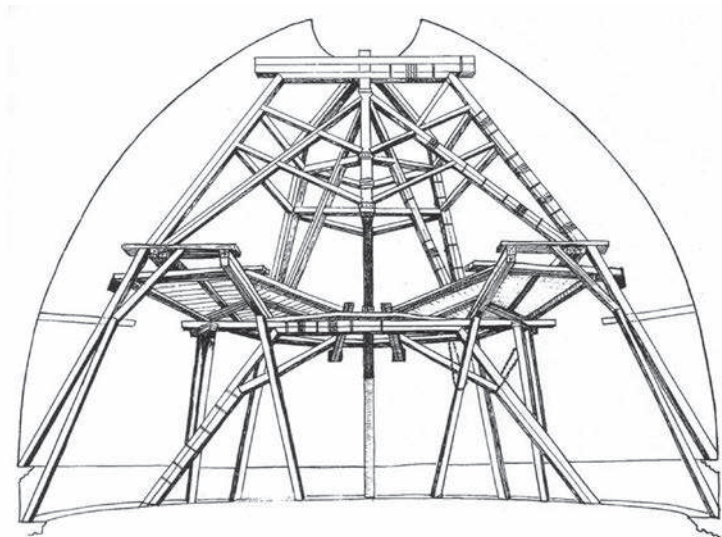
Demonstração dos andaimes para a construção da cúpula de Santa Maria del Fiori (1419). Brunelleschi, quando é nomeado único arquiteto da obra.
